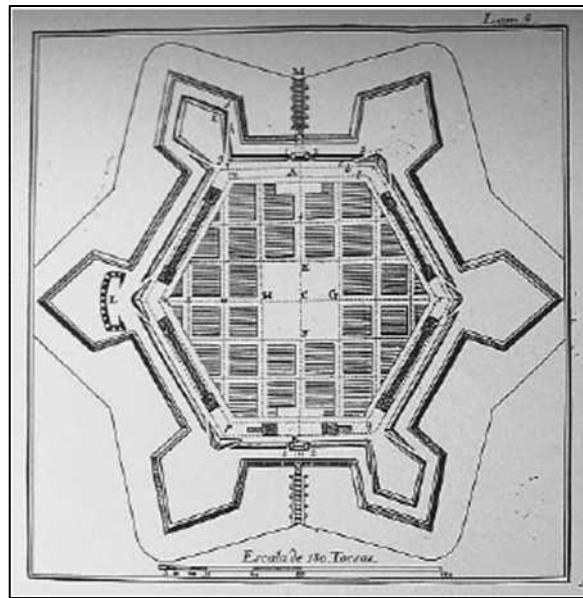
Le Blond. planta de ciudad hexagonal fortificada con trazado interior ortogonal (Elementos de fortificación. 1776. lámina 4).
